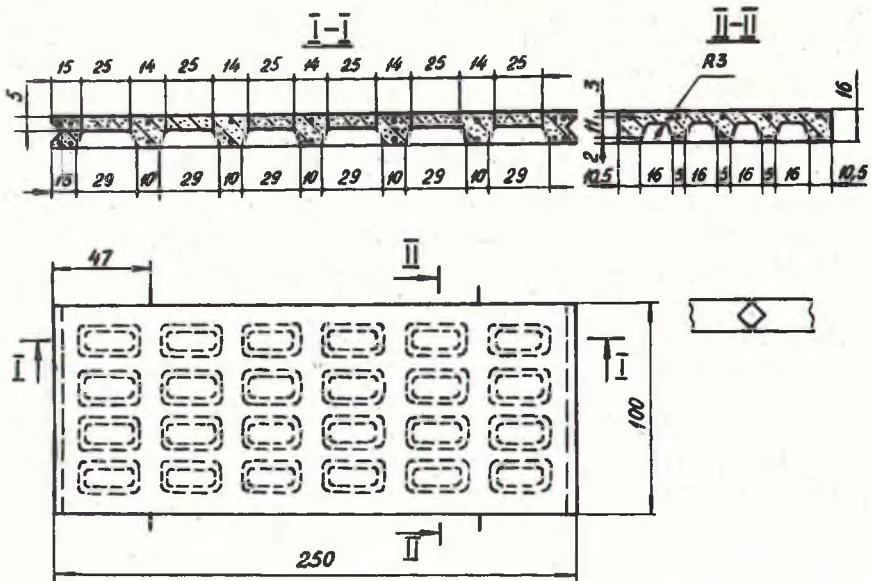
Аглопоритожелезобетонная дорожная плита:
